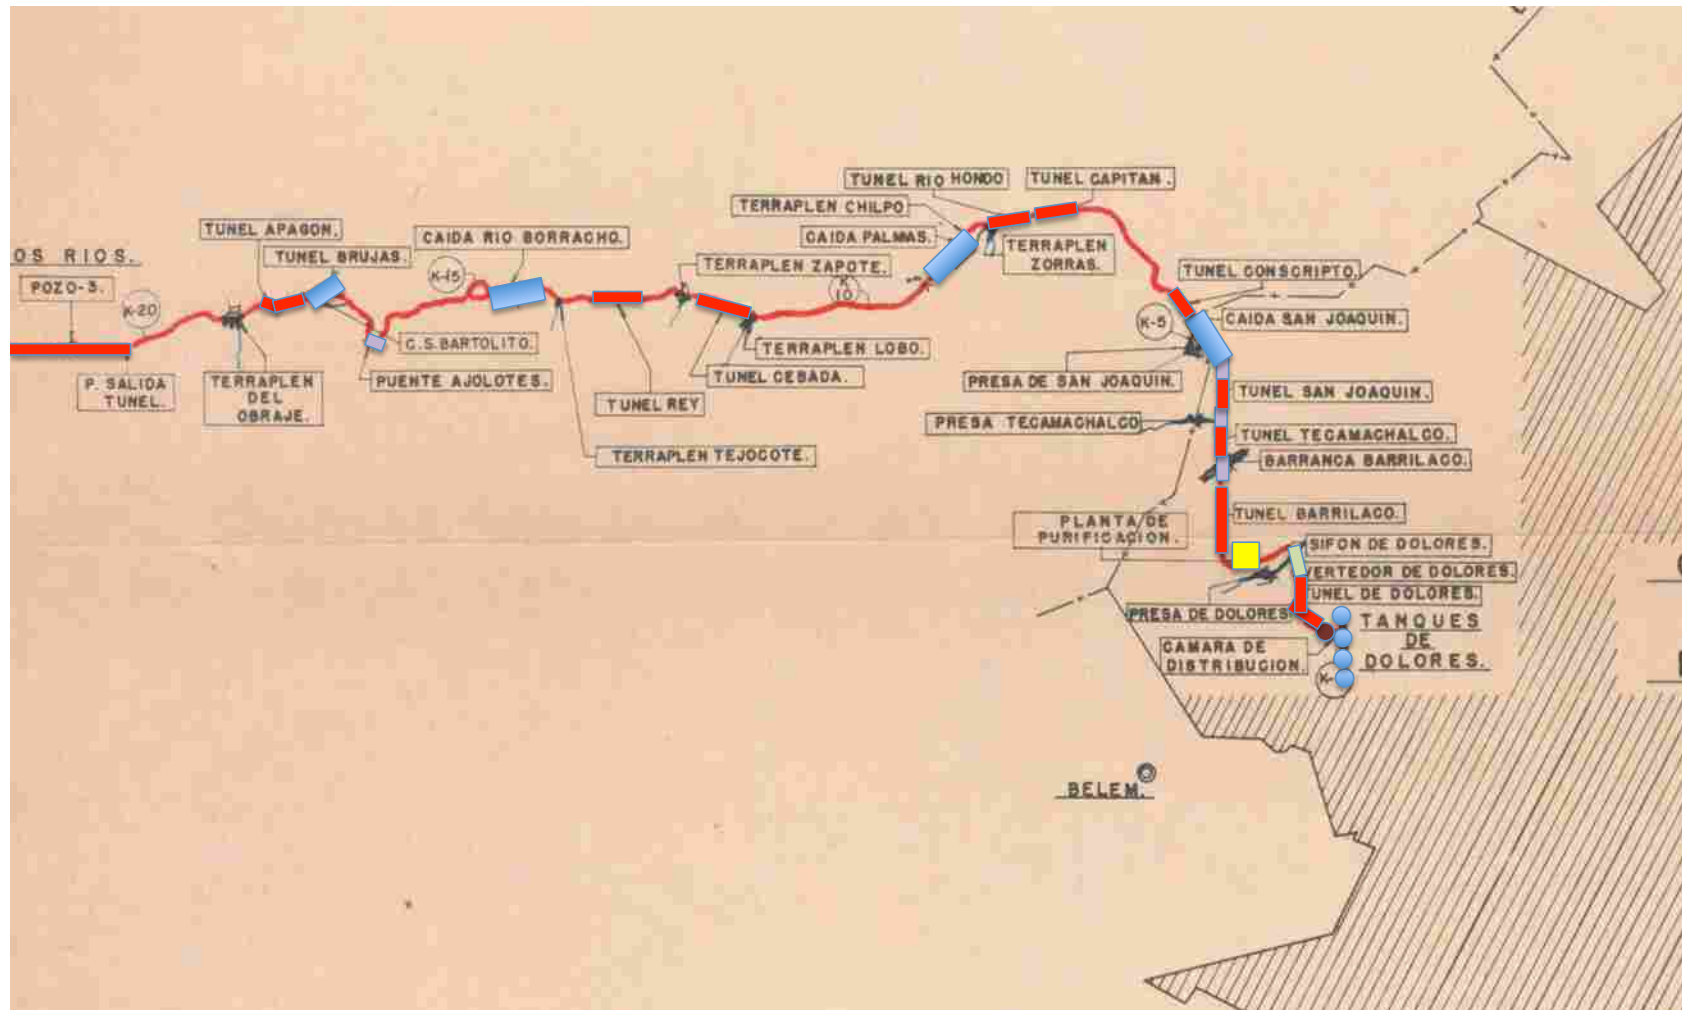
Llegada del Sistema Lerma, elaboración propia sobre el plano del Sistema Lerma
